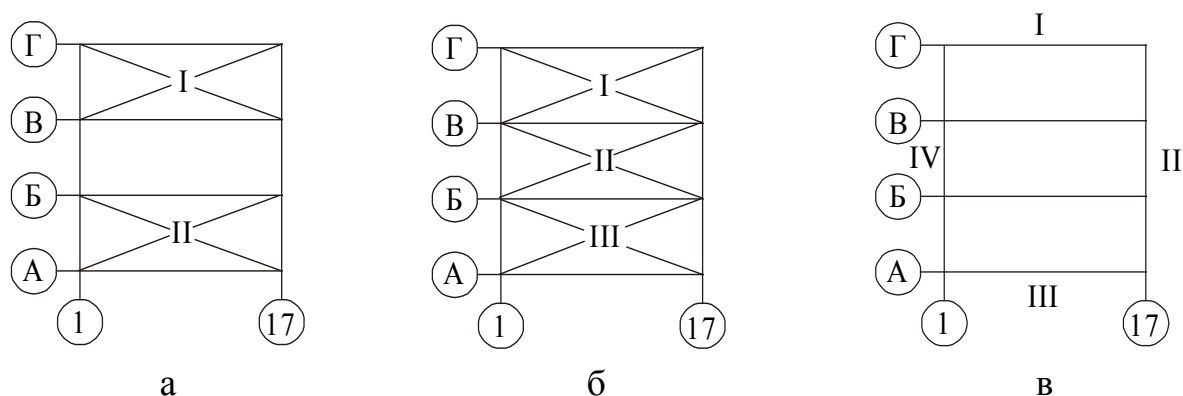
Схеми розбивки будівлі на захватки:
